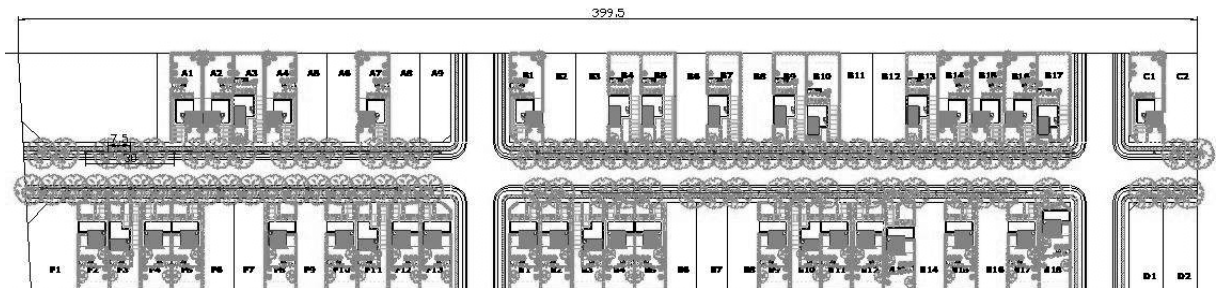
Planimetría del Conjunto de Vivienda Seleccionado.
